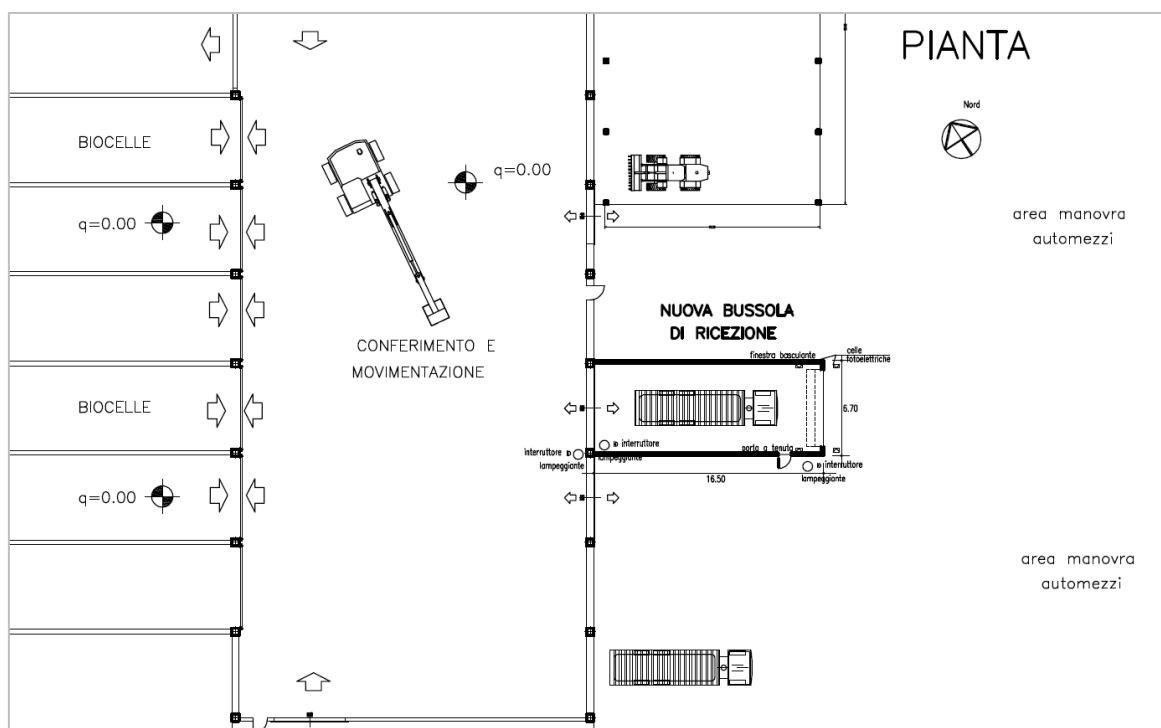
Stralcio planimetrico del progetto di realizzazione della bussola di ricezione.
